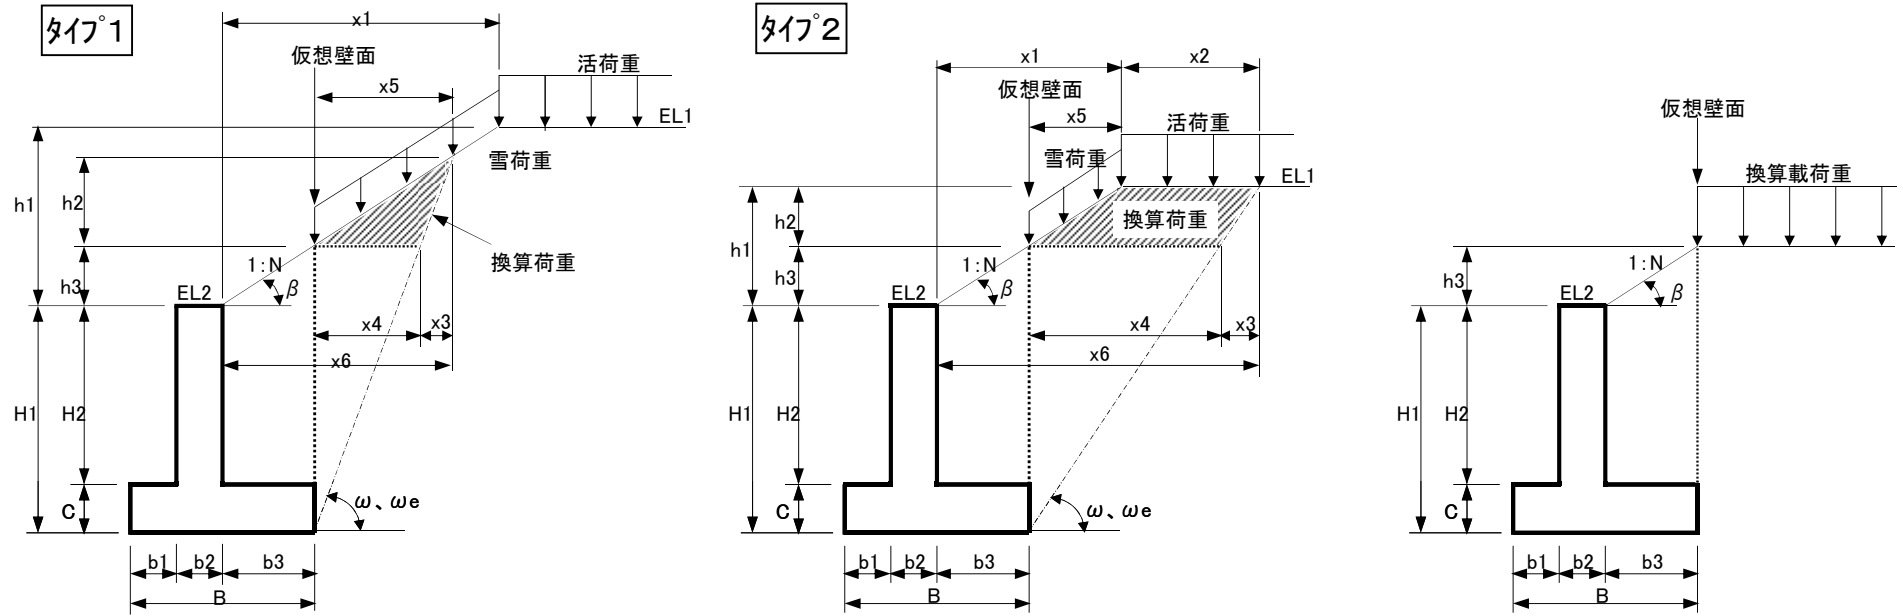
土圧がたて壁に作用する場合(たて壁の設計)
